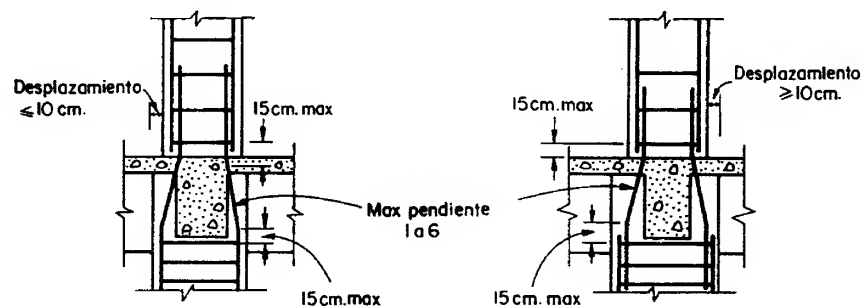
ARMADURA LONGITUDINAL EN COLUMNAS
